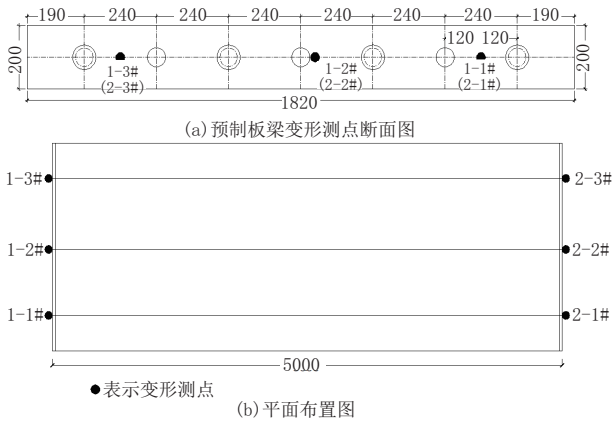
预制板梁变形测点断面及平面布置图(单位:mm)
